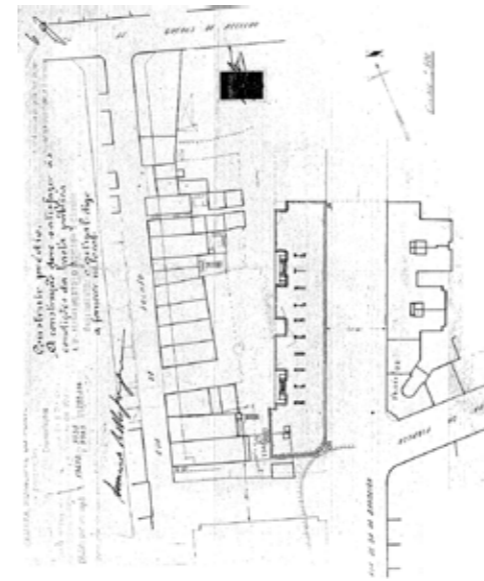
Planta de implantação do licenciamento nº 272 de 1945
